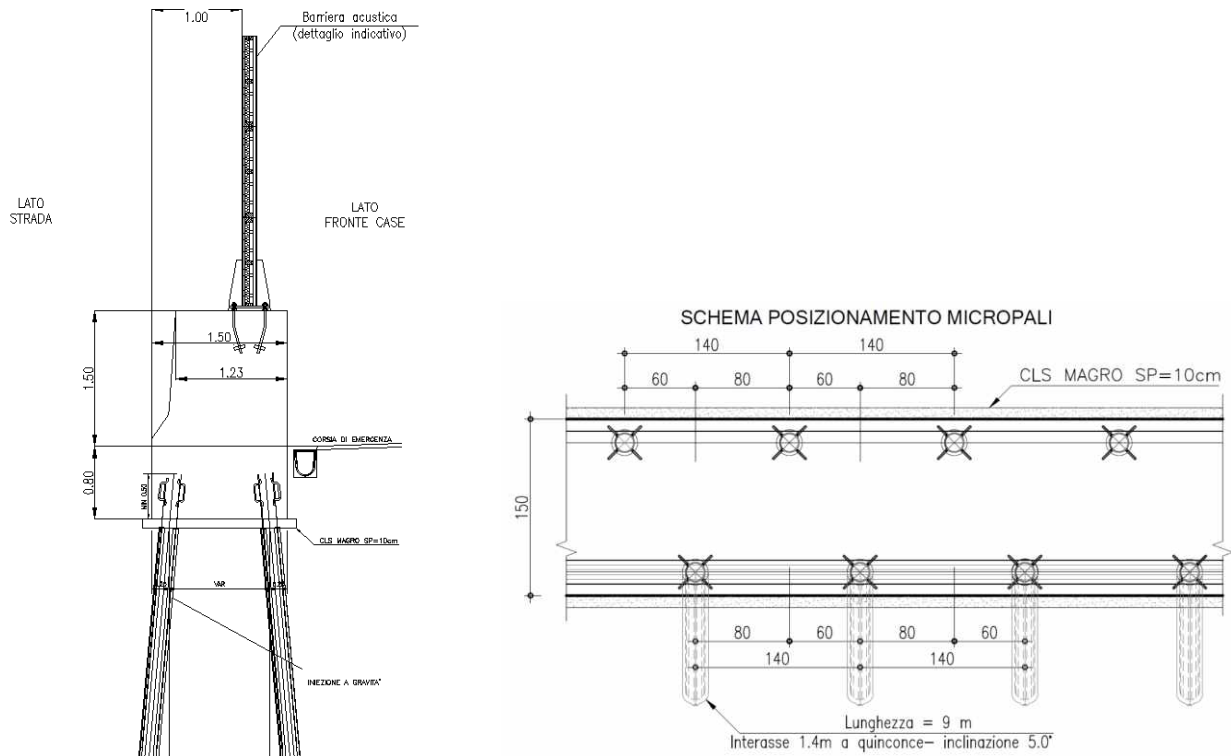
sezione muro + fondazione FOA Tipo 1
